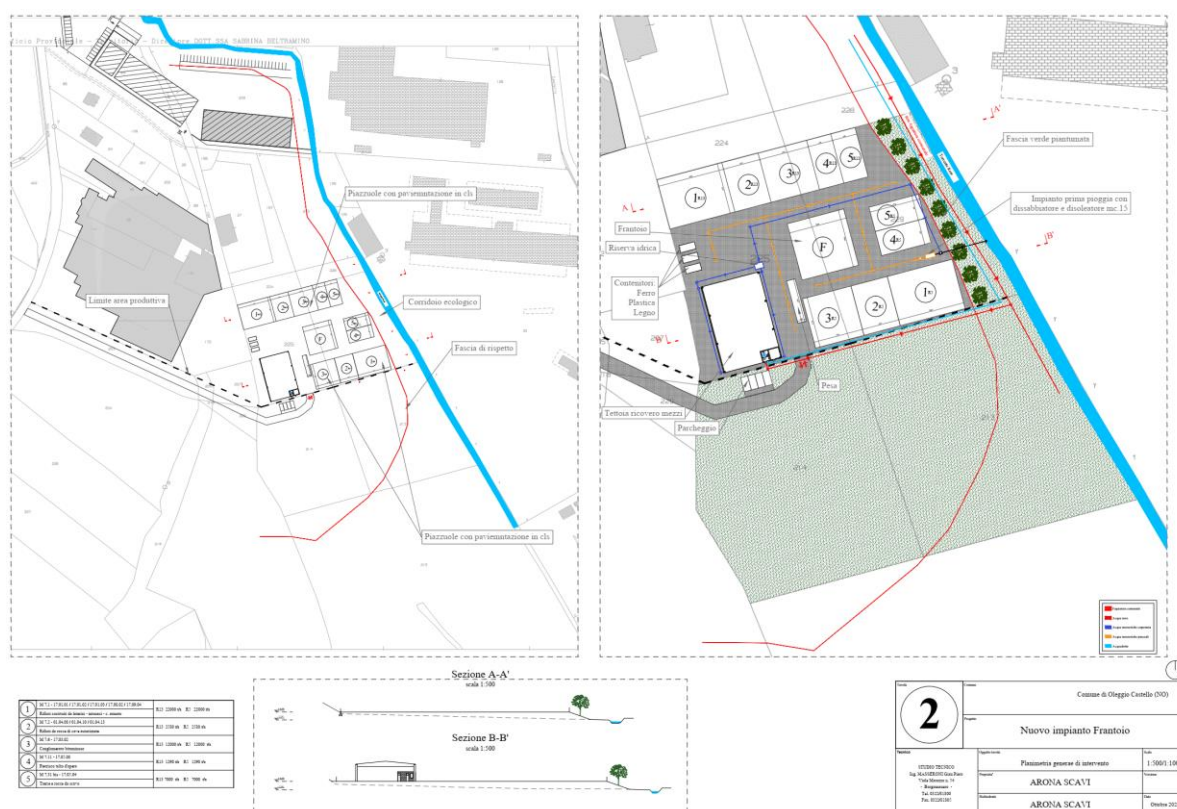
planimetria del nuovo impianto in progetto (Tav. 2)
